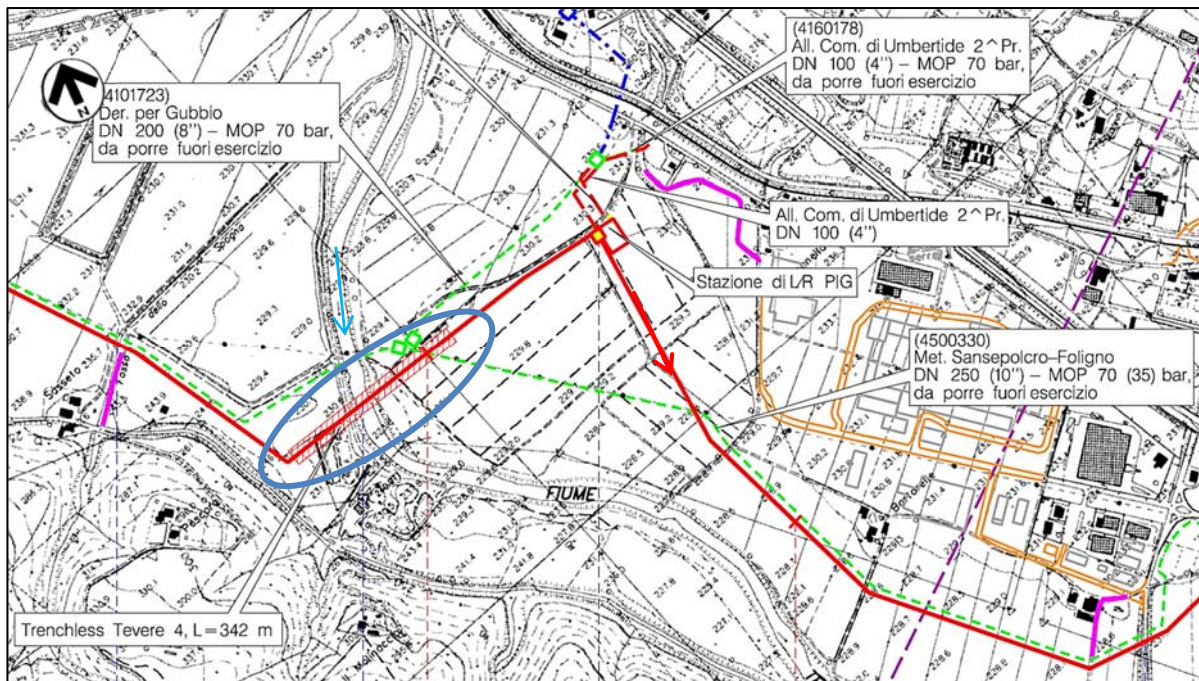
/B – Stralcio CTR con localizzazione dell'attraversamento
